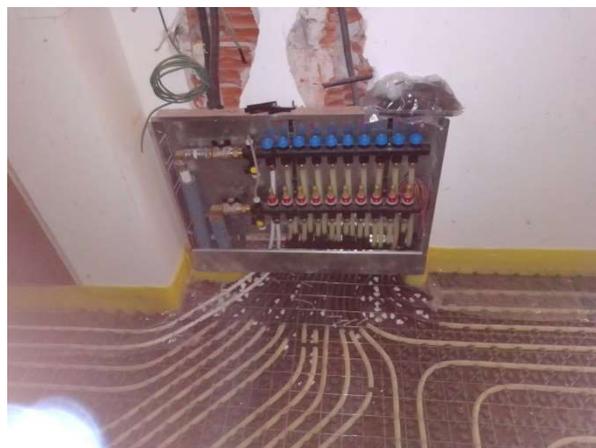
Installazione e posa pannelli radianti a pavimento
